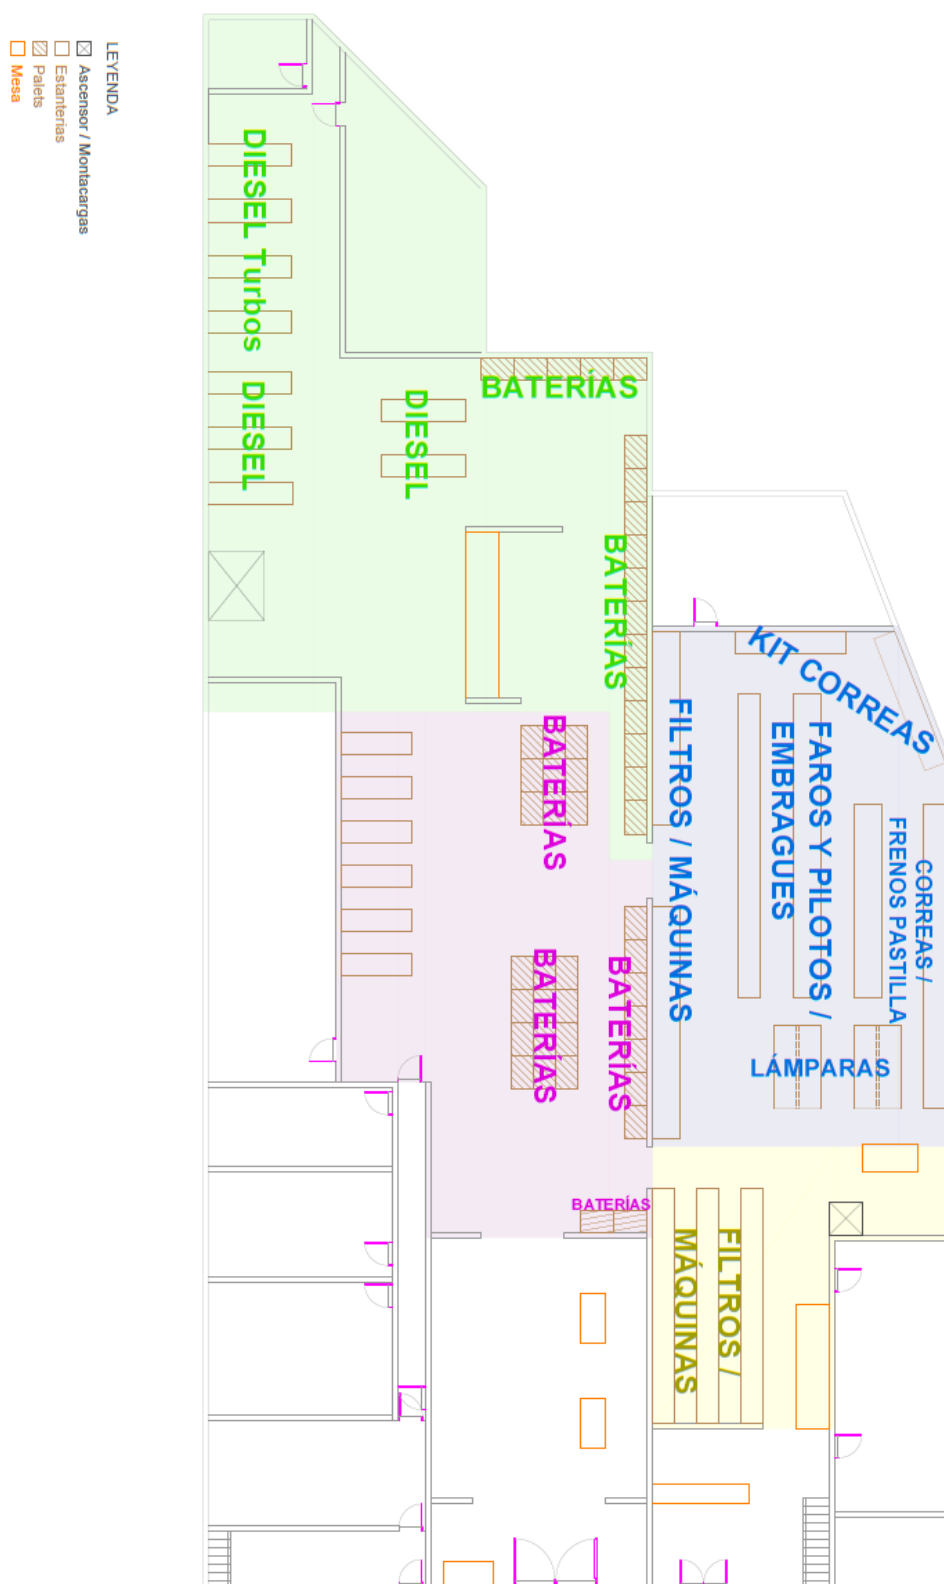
Imagen del plano situación de piezas planta baja (Anexo D: P007)
